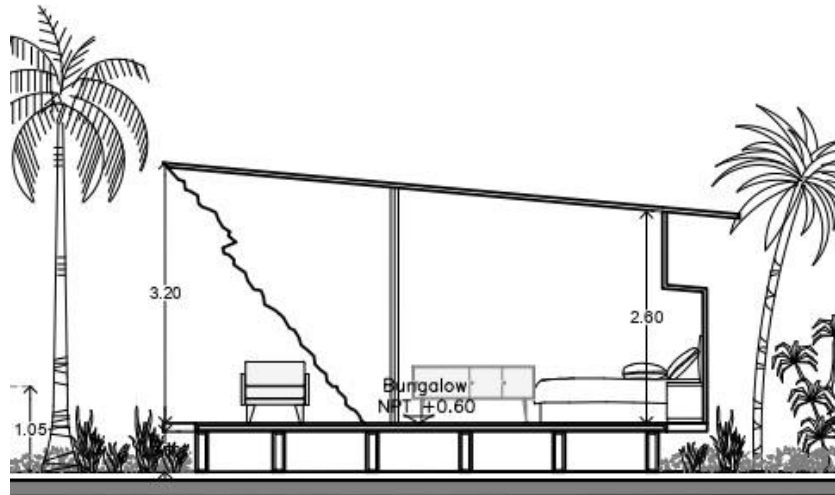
Bungalow realizado con material de concreto sobre pilotes.
